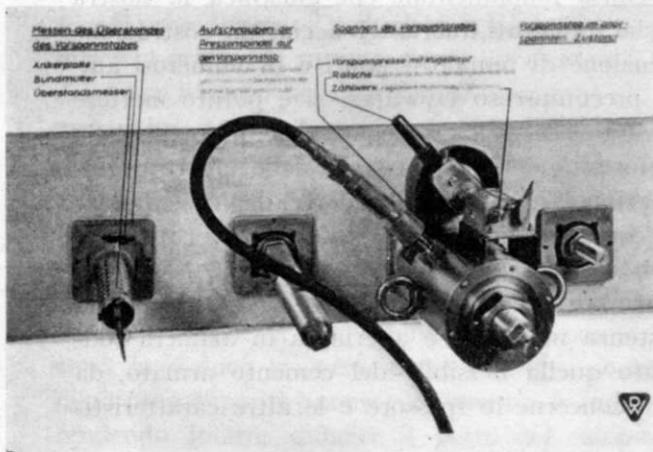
Dispositivo di messa in tiro dell'armatura.
